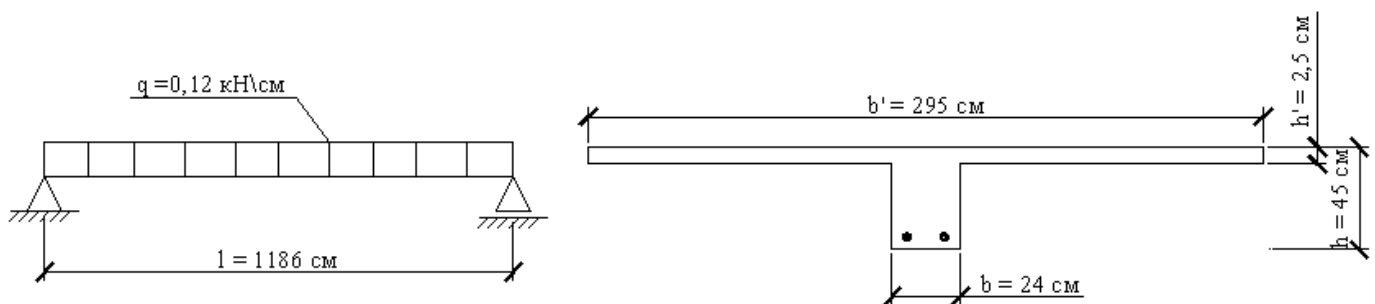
Розрахункова схема та зведений розрахунковий переріз поздовжніх ребер
